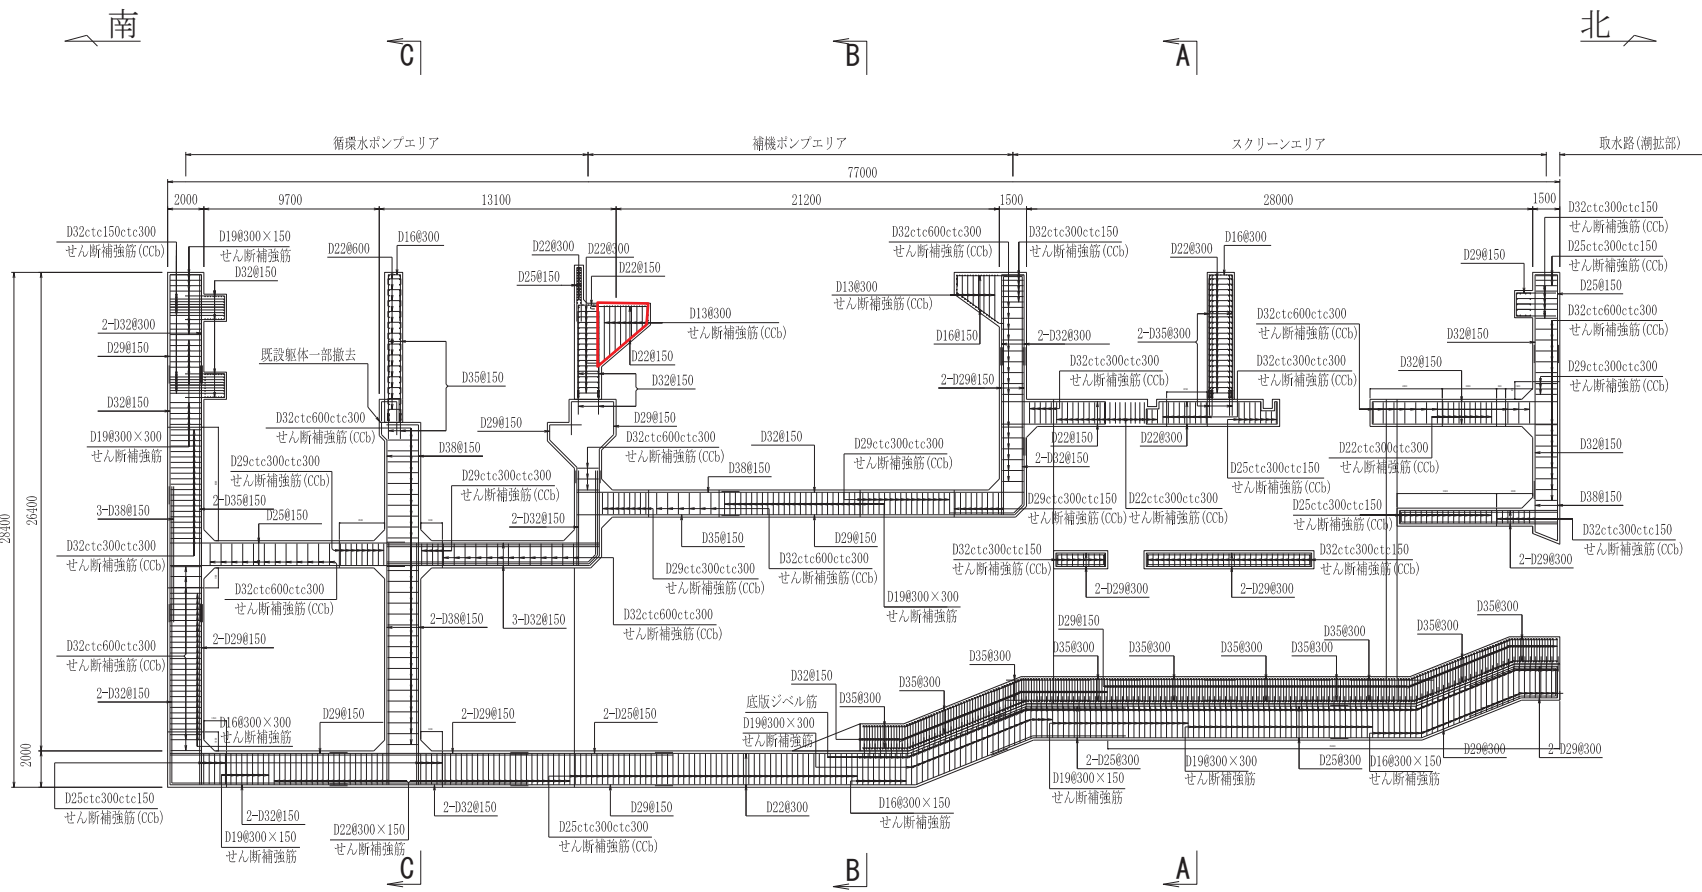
海水ポンプ室概略配筋図 (B-B 断面, 東西)
